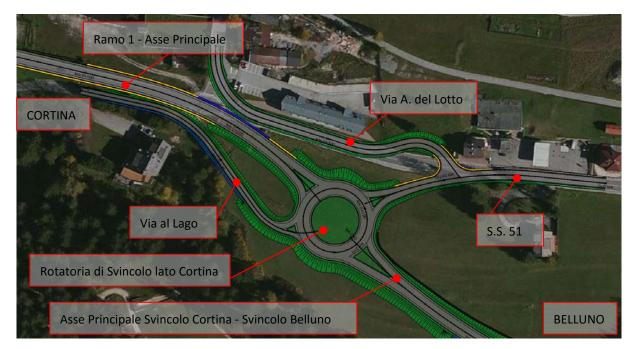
Stralcio Planimetrico Ramo 1 - Asse Principale
